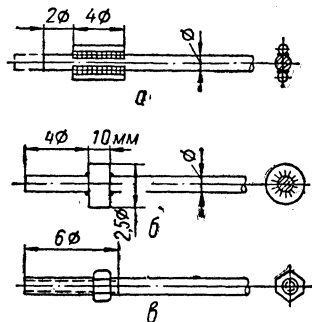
Анкеровка стержневой арматуры круглого профиля:
